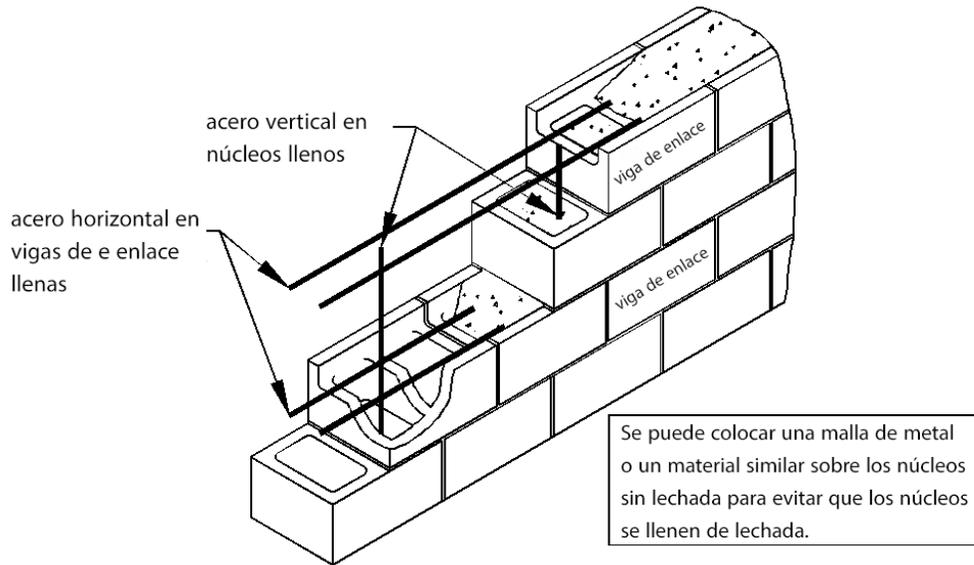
DETALLES TÍPICOS DE REFUERZO DEL MURO
